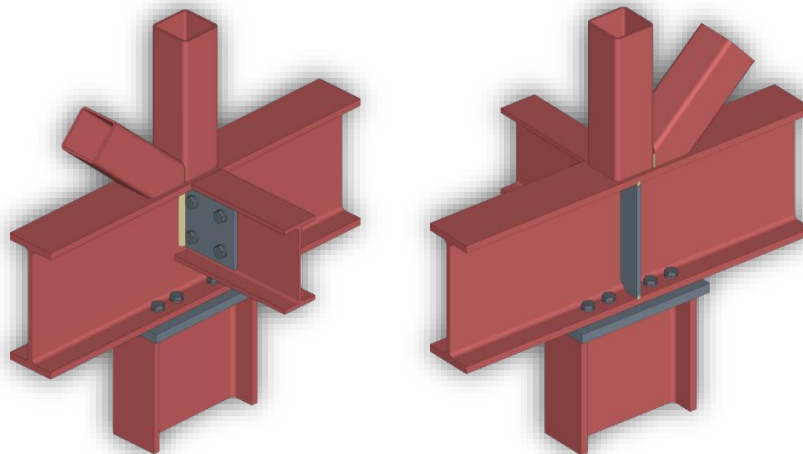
Unión apoyo vertical, tablero y viga reticulada
